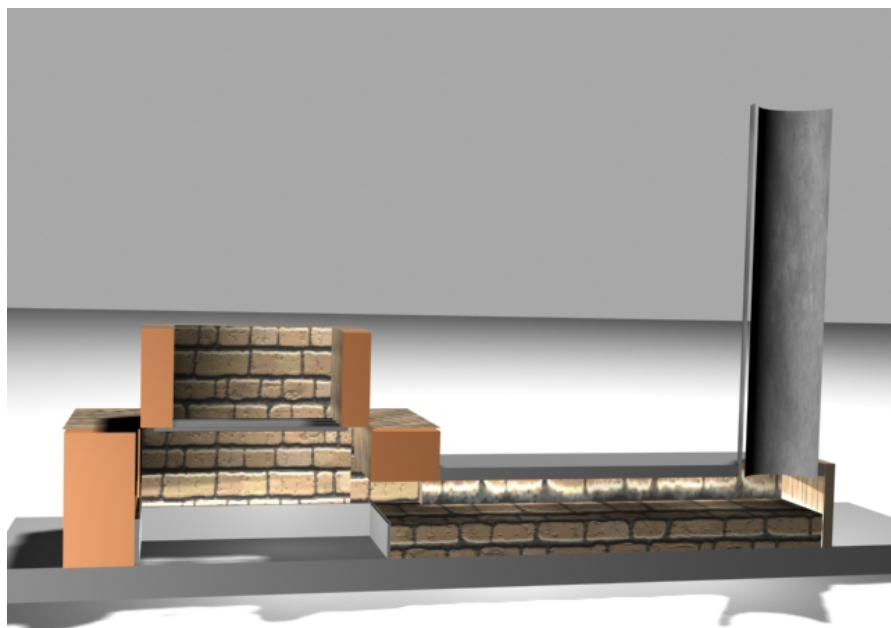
CORTE LONGITUDINAL DA FORNALHA
